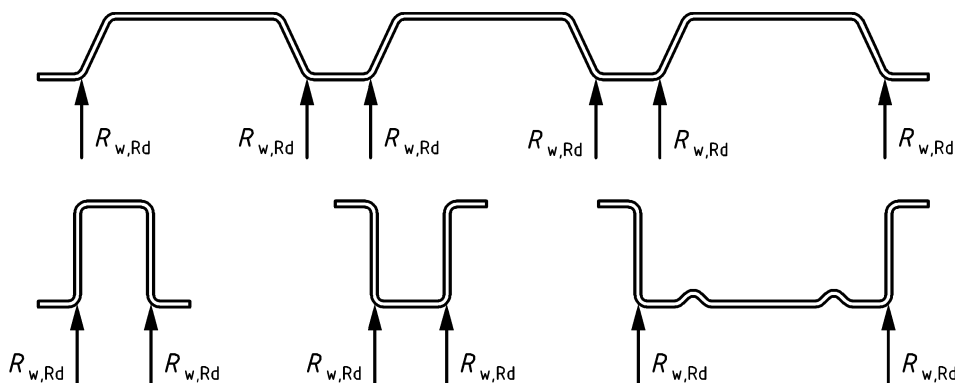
Beispiele für Querschnitte mit zwei oder mehr Stegen
